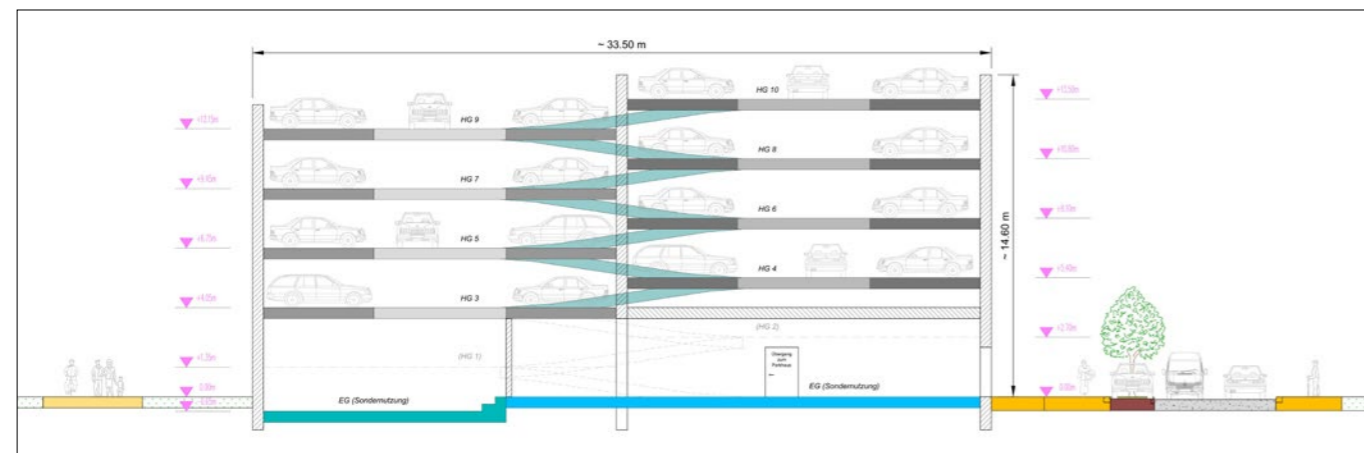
Schnittskizze einer Bewohnersammelgarage mit Einzelhandelseinrichtung
